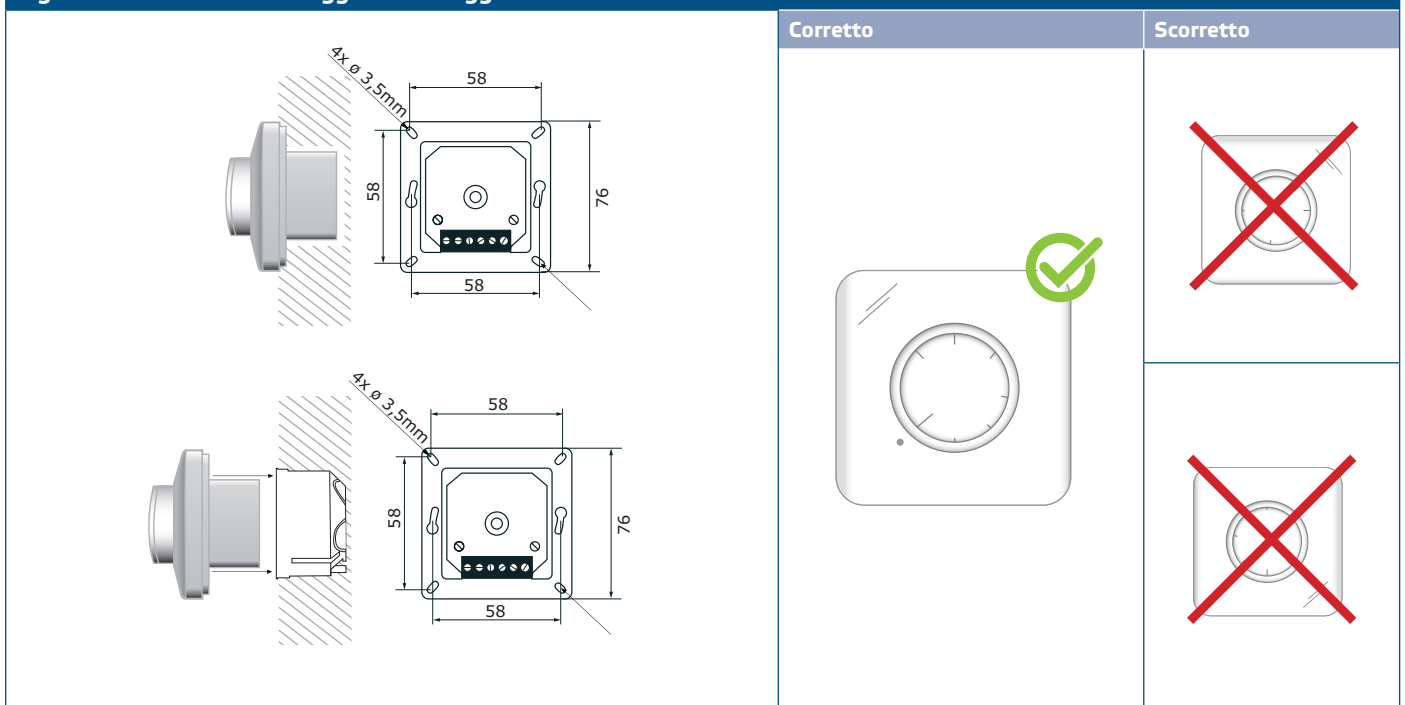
Dimensioni di montaggio - montaggio da incasso
